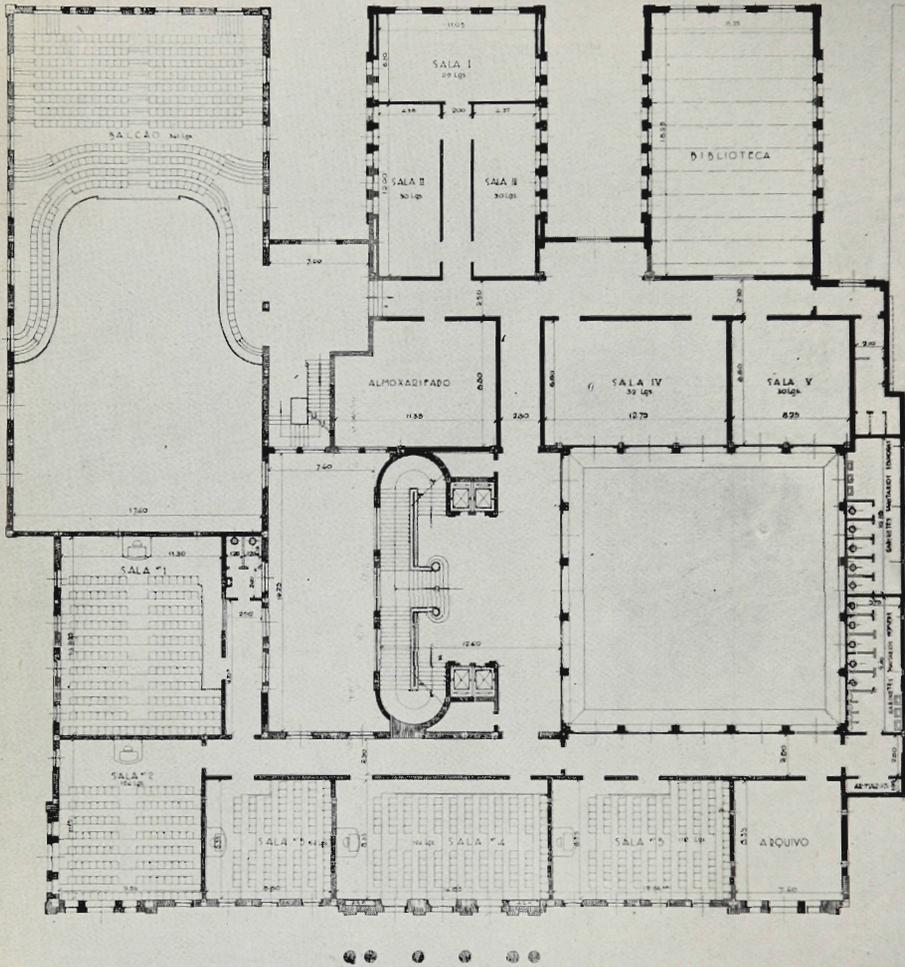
Planta do novo edificio — 3.º pavimento.
